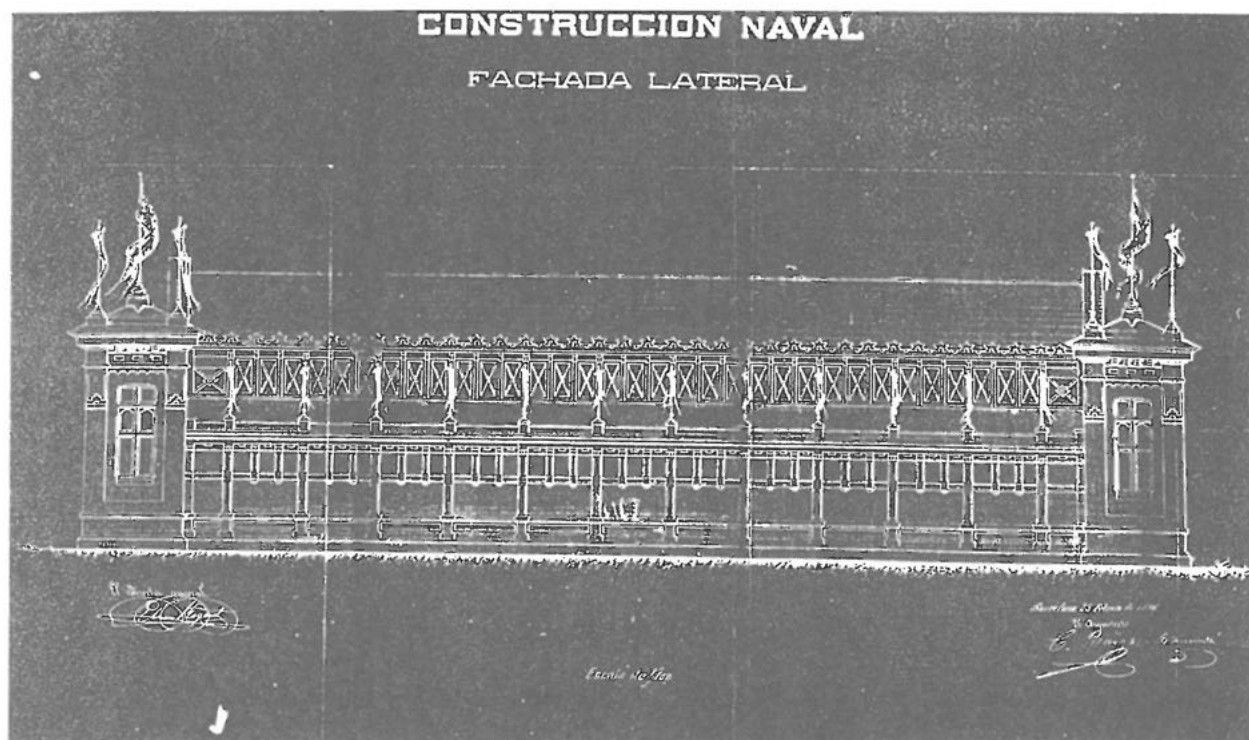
Fachada lateral del Pabellón de Construcción Naval. Fotografía Cátedra Gaudí.
